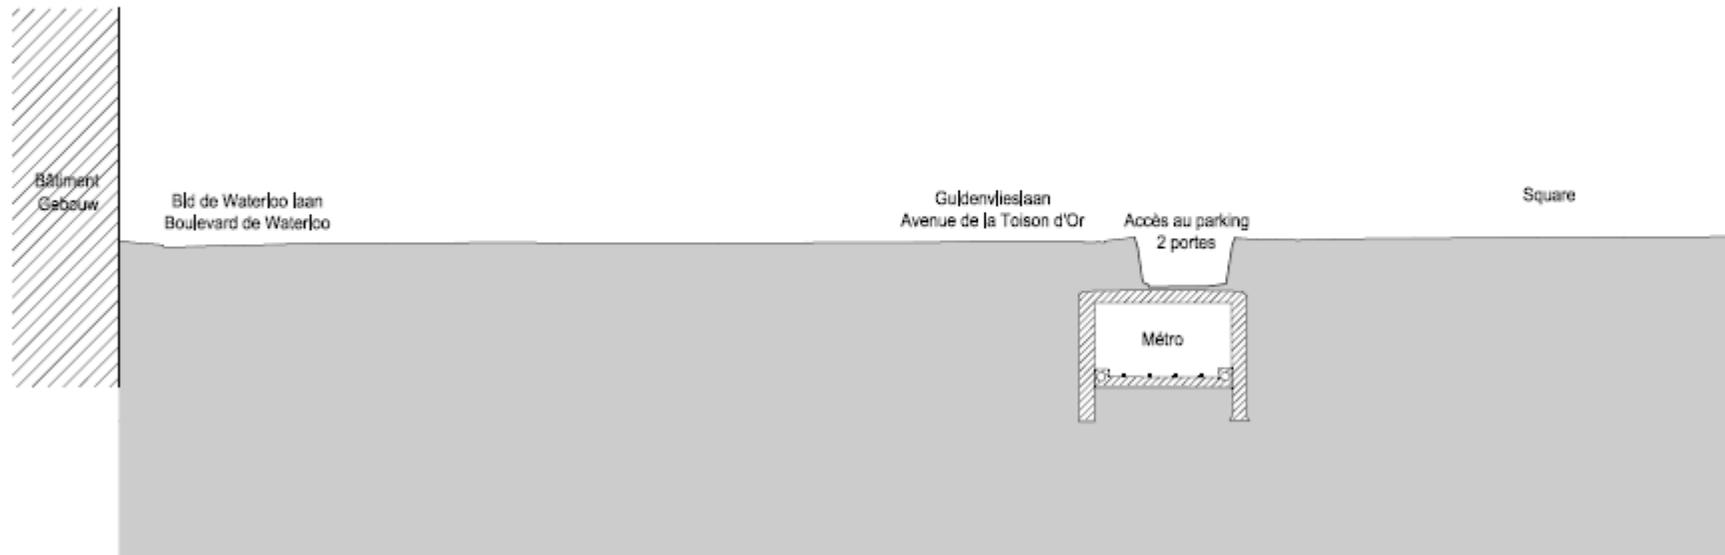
Coupe transversale 2 de la zone du projet dans la situation existante.
